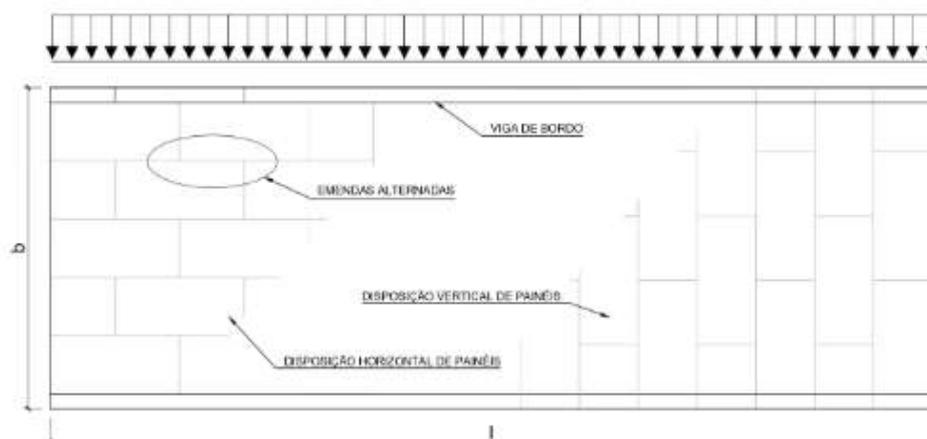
Carregamento de painel de diafragma e disposição dos painéis de contraventamento
